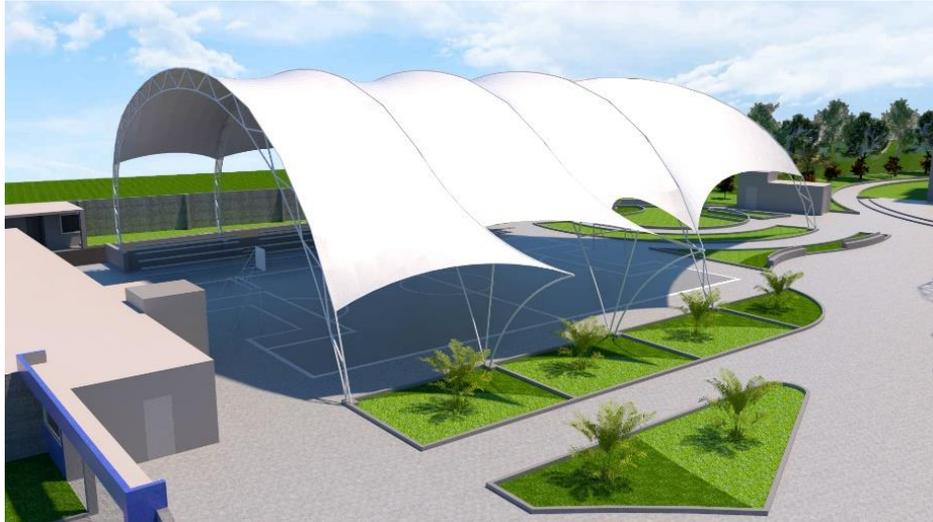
Vista de cubierta de Losa Deportiva. Elaboración Propia.
